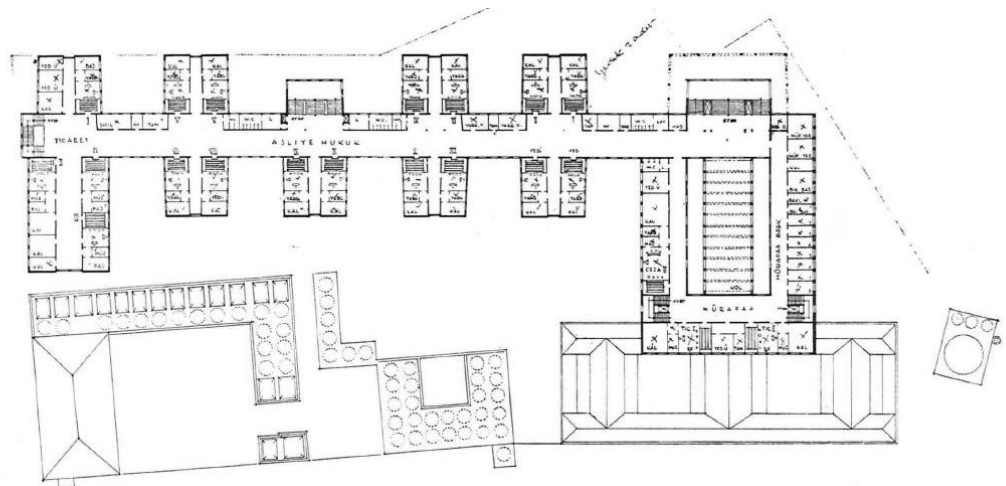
Adalet Sarayı Bodrum Kat Planı (Aziz, et al., 1949)
